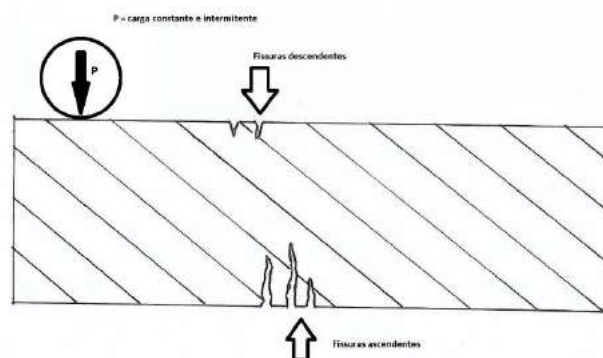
Esquema de fissuras descendentes e ascendentes (Figura do autor)
